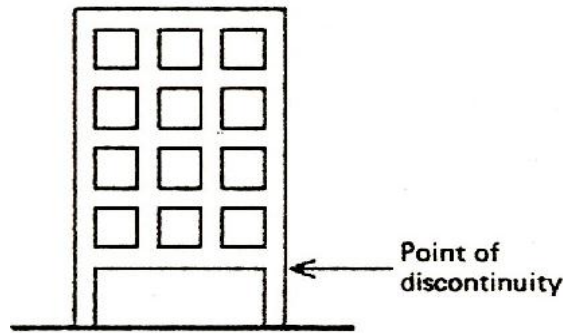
Spatial Interpenetration pada Lantai-lantai Di bawah Lantai-lantai Tipikal
